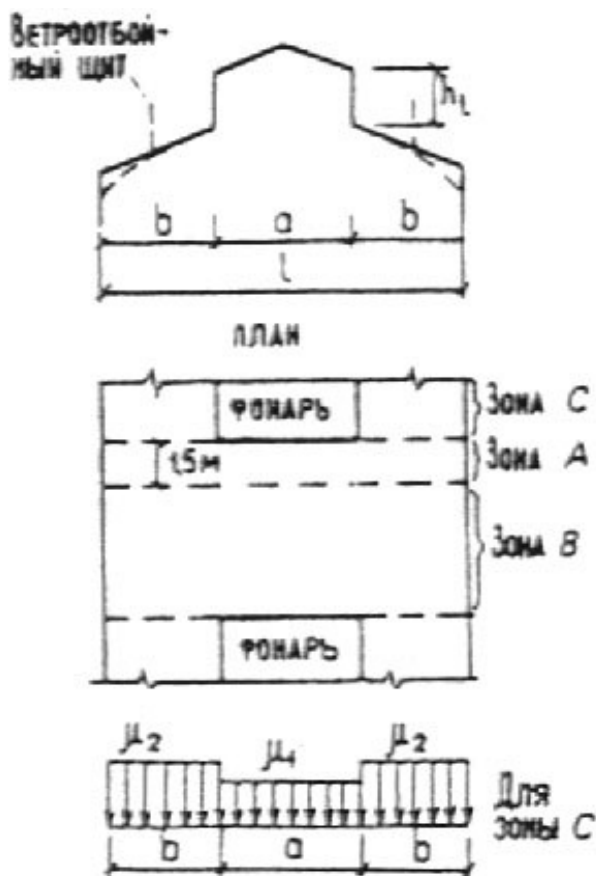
Схема покрытия с фонарём (сверху) и эпюра распределения снеговой нагрузки (снизу)
